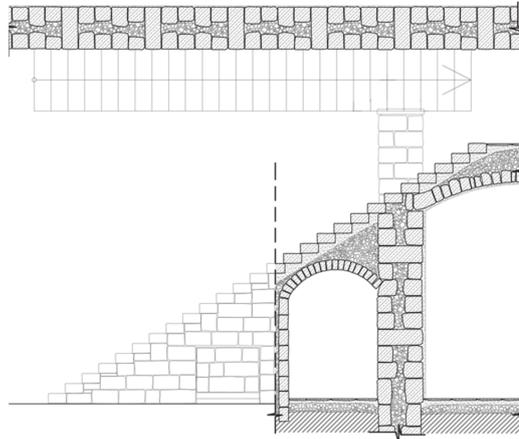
Treppen auf Gewölbekonstruktion– Grundriss & Schnitt
